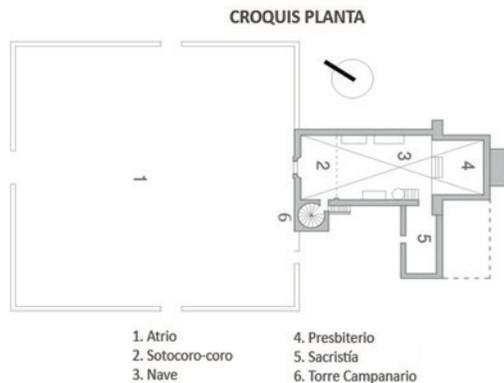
A. Croquis, de planta arquitectónica de Santa María Huatlatlauca, Puebla.
